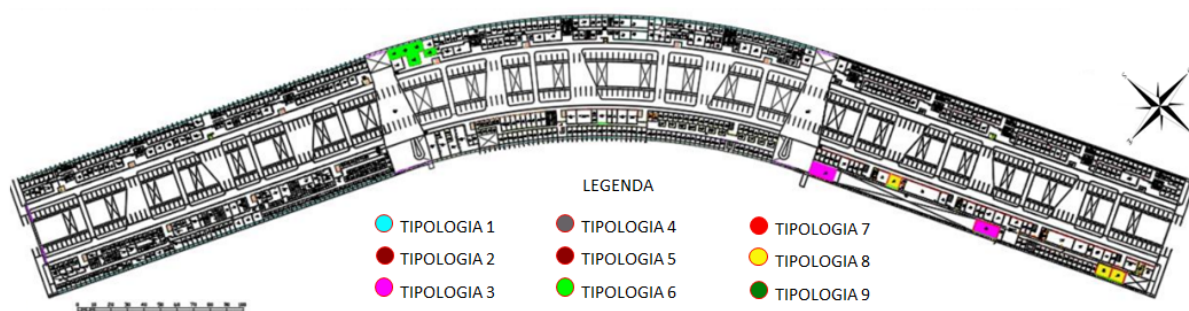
Planta baixa primeiro pavimento ICC/UnB.
